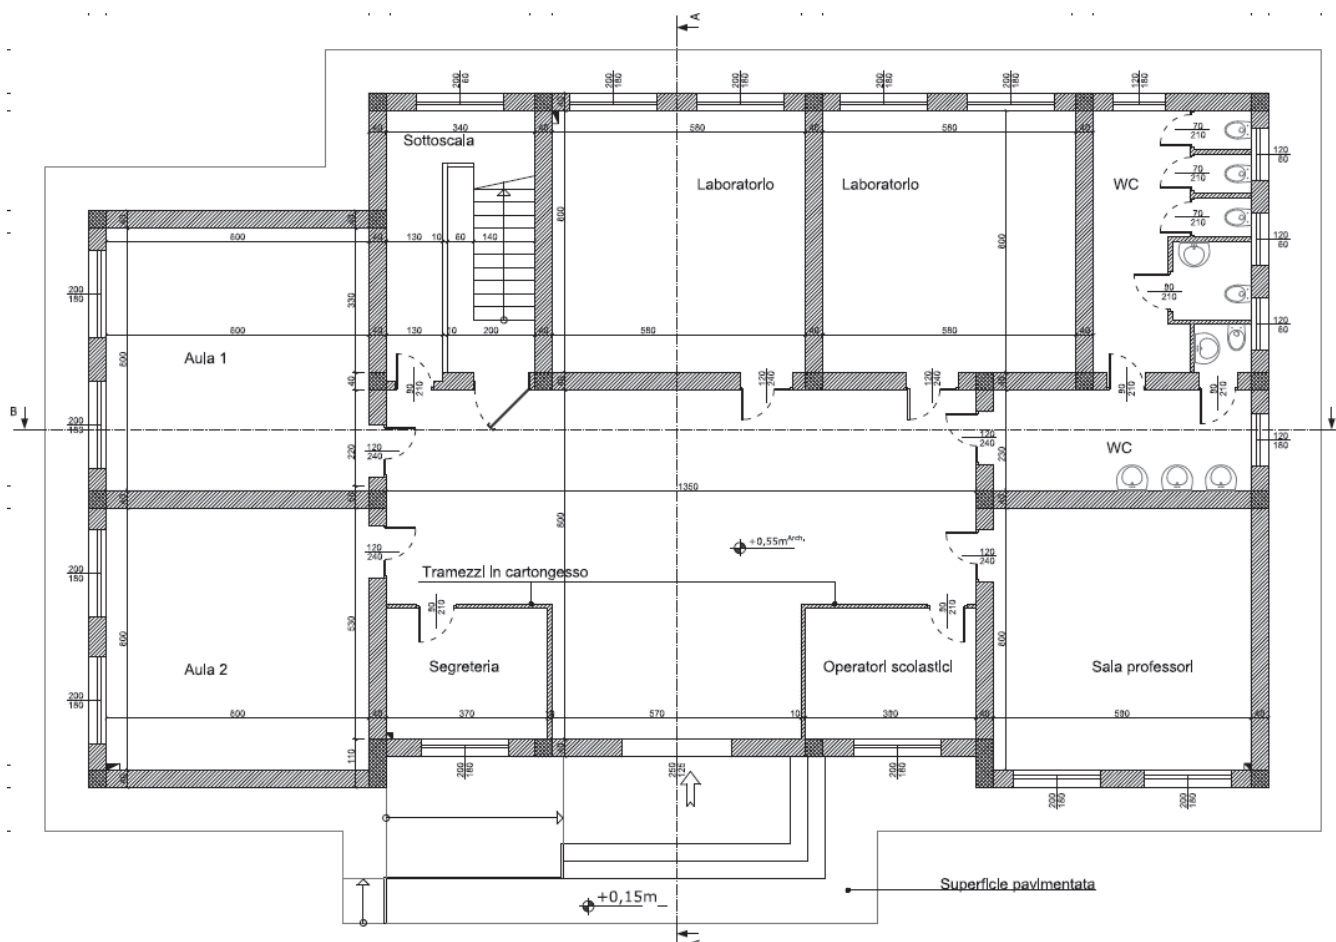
Pianta Piano Rialzato dell'Edificio
